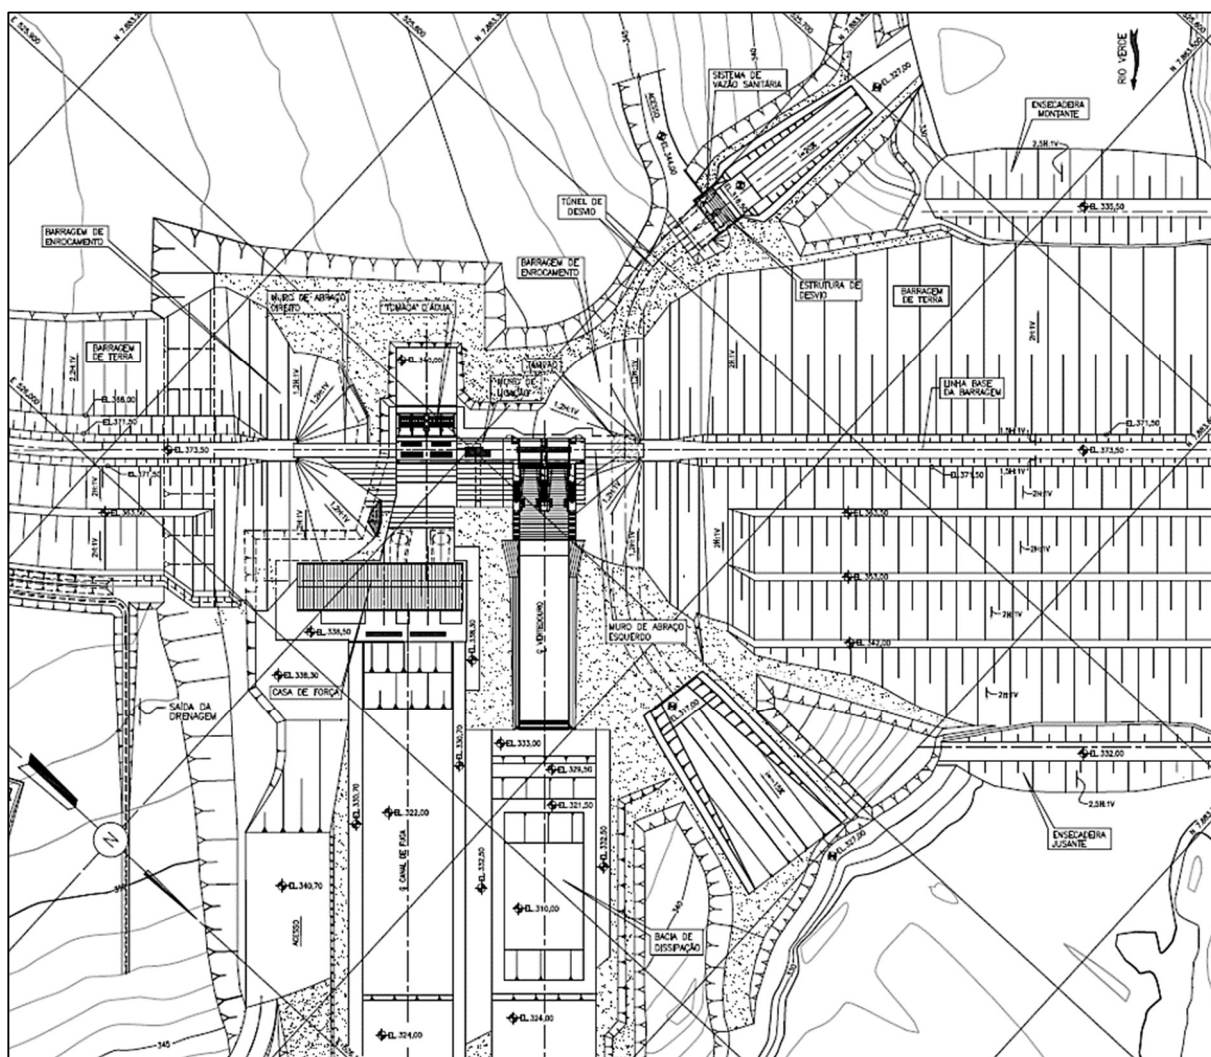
Posição em planta do Vertedouro Controlado no Arranjo Geral da UHE Salto do Rio Verdinho.
